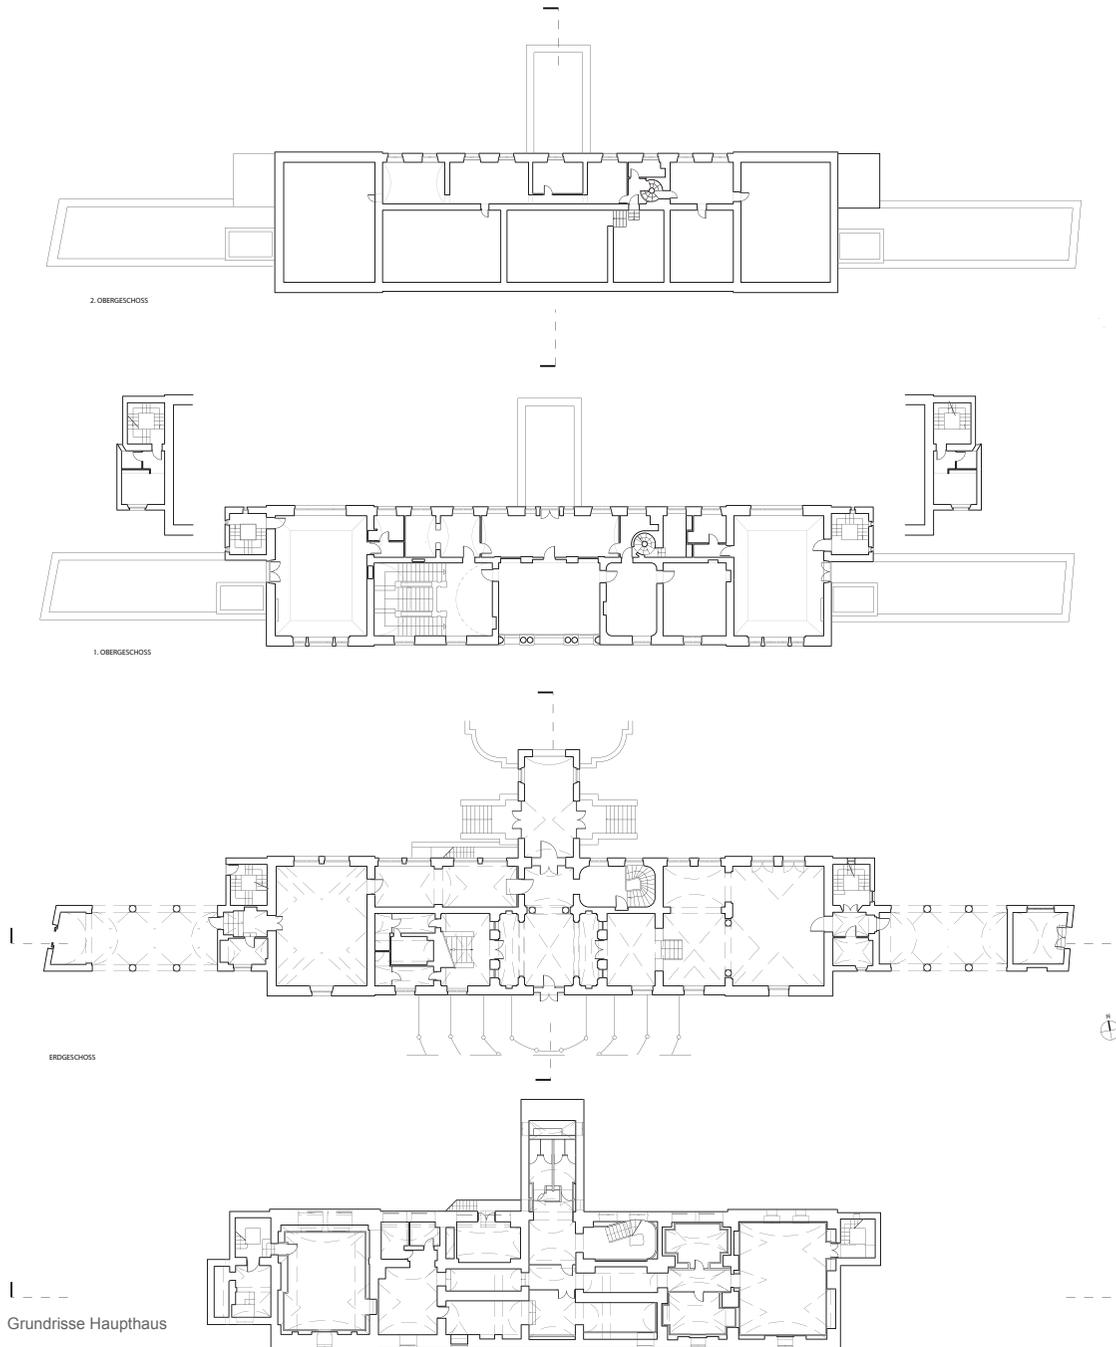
Grundrisse Haupthaus
